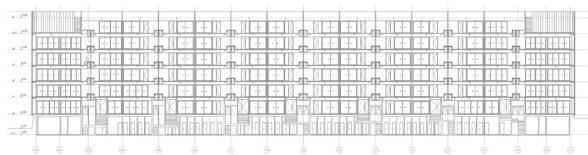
Seção Longitudinal - Terraçoes Elevação Oeste.
